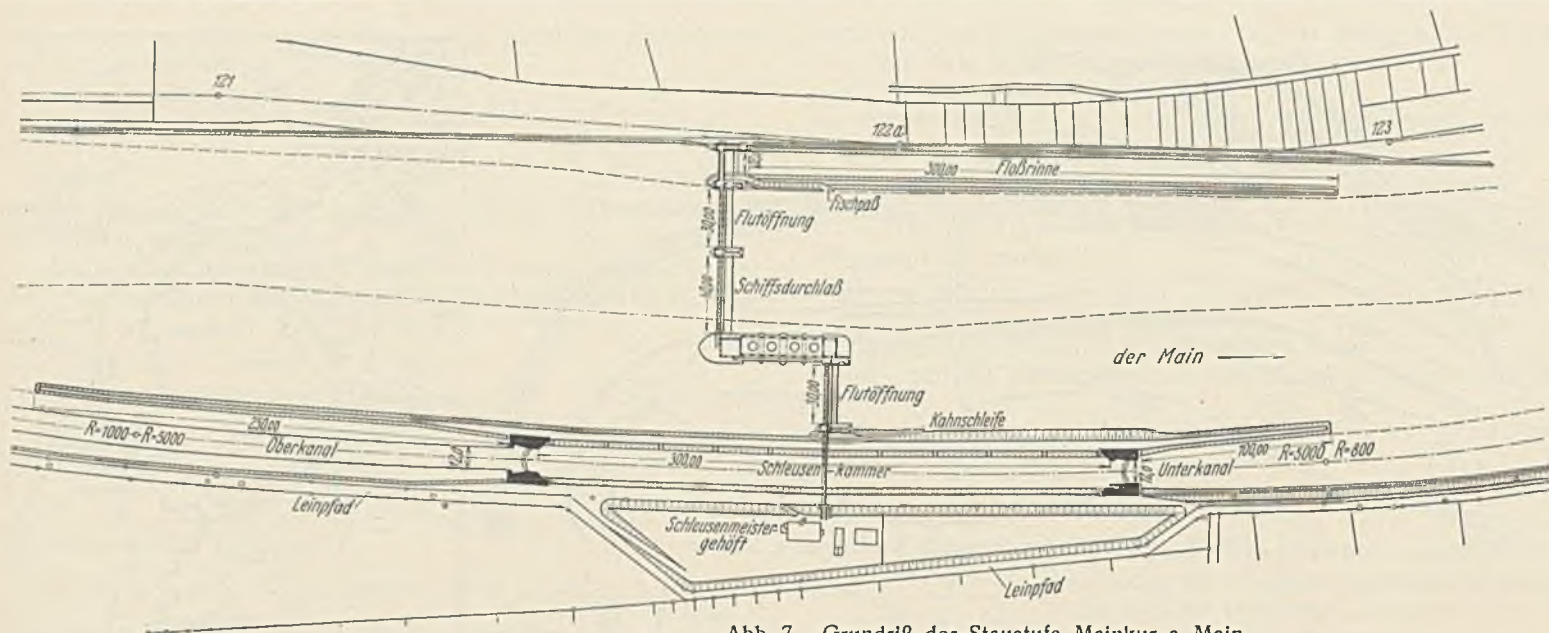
Grundriß der Staustufe Mainkur a. Main.
